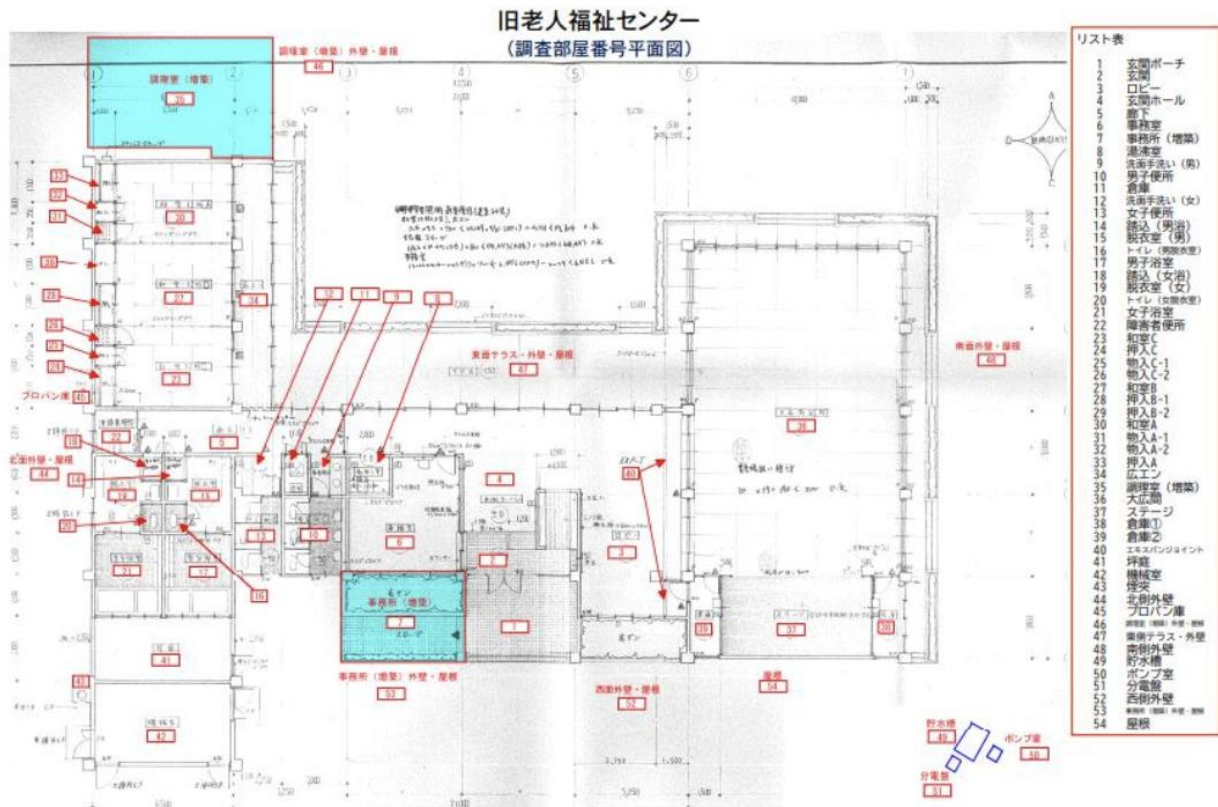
調査部屋番号平面図（動線計画図）（建築物の例）
